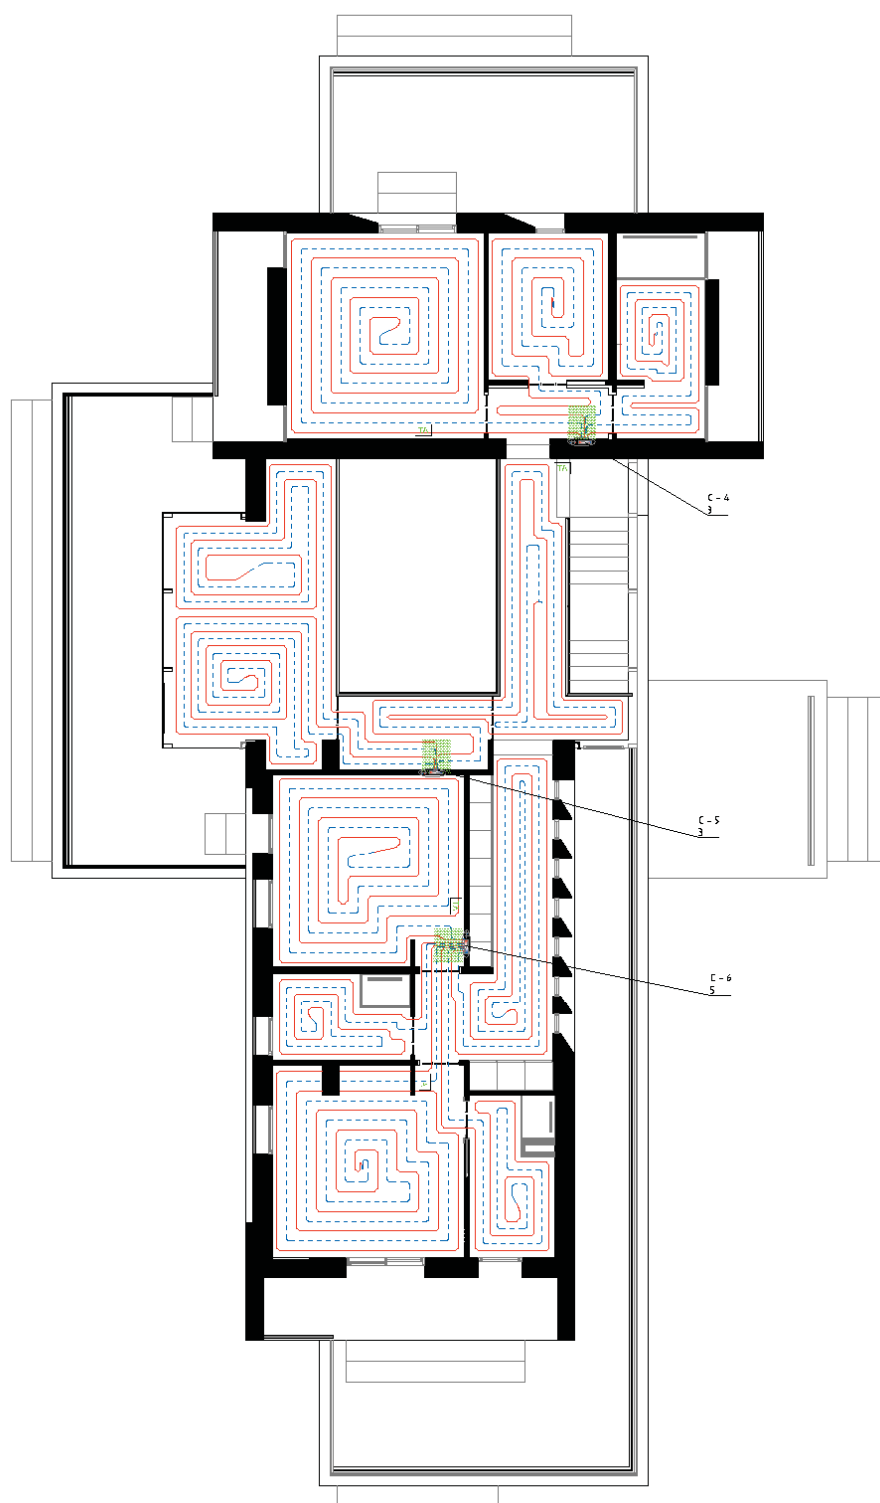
Schema di posa pannello radiante a pavimento piano primo
